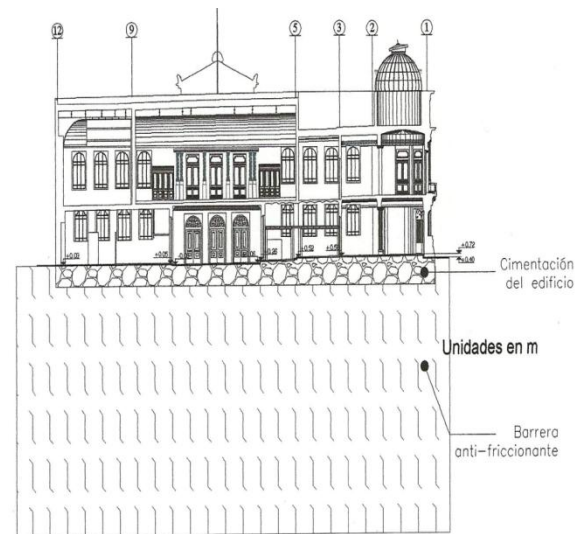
Corte de la zanja con material anti-friccionante sobre la fachada Oeste [2.17].
